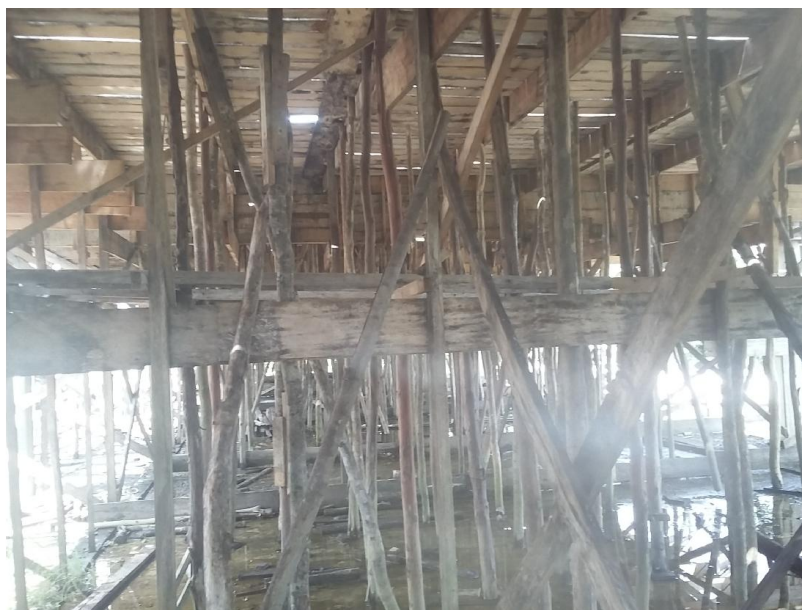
Vista dos cimbramentos que sustentam as formas das lajes de cobertura na ASA DIREITA.
